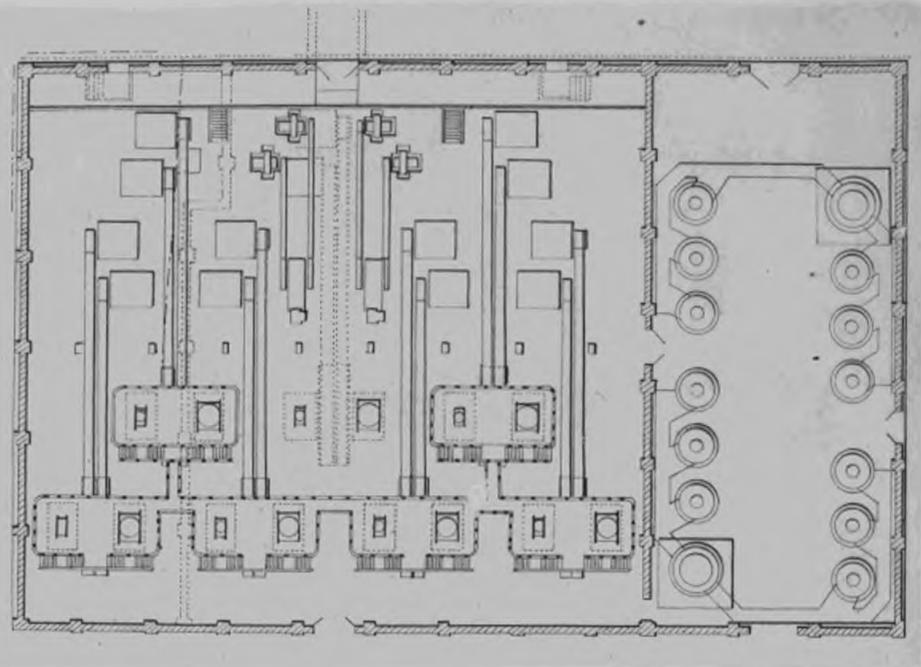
TRAMWAY DE NEW-JERSEY. PLAN DE LA STATION DE FORCE
